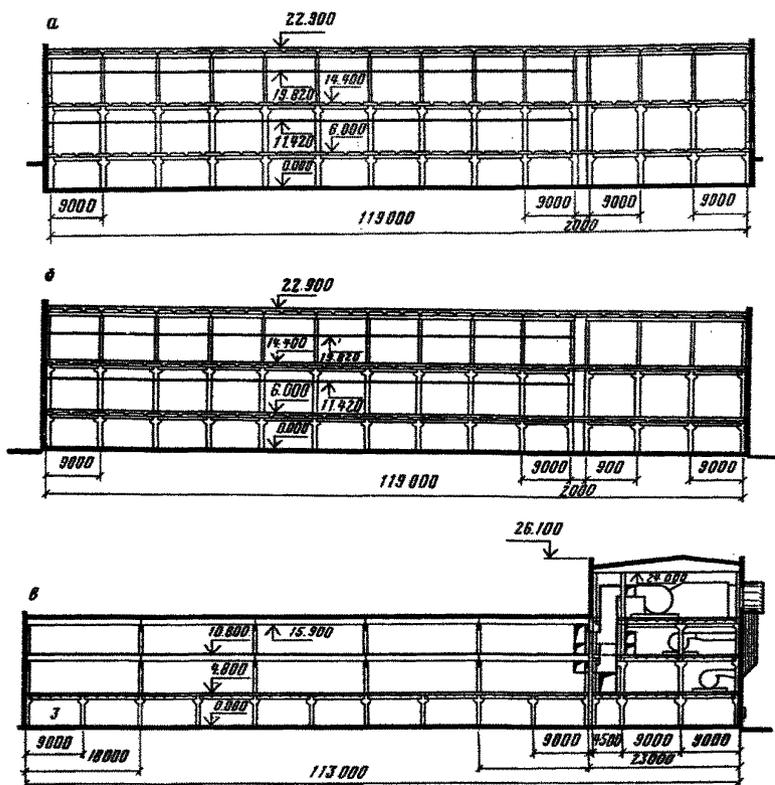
Многоэтажное производственное здание без подвалов для прядильно-ткацких предприятий
